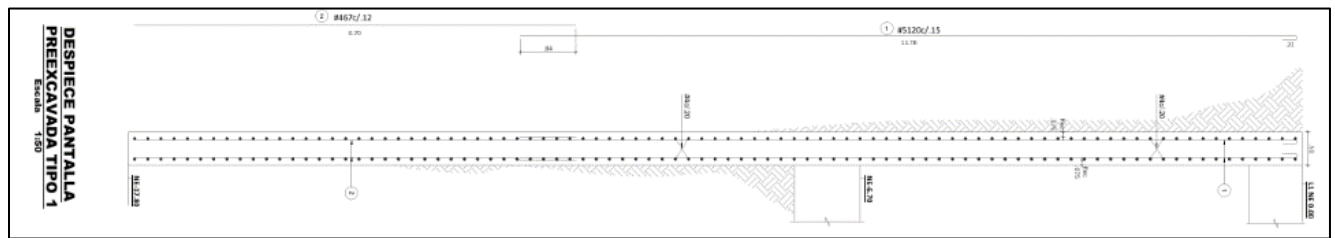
Detalle Despiece del Elemento Pantalla MP – 92 – T1.
